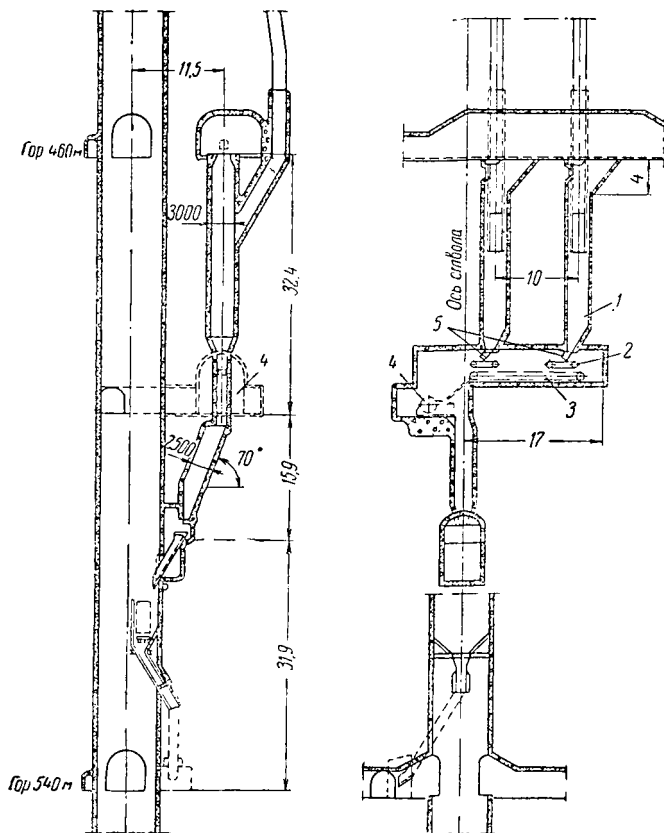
Общий вид подземного бункера с люками, снабженными питателями и пластинчатым конвейером для подачи руды в дробилки
